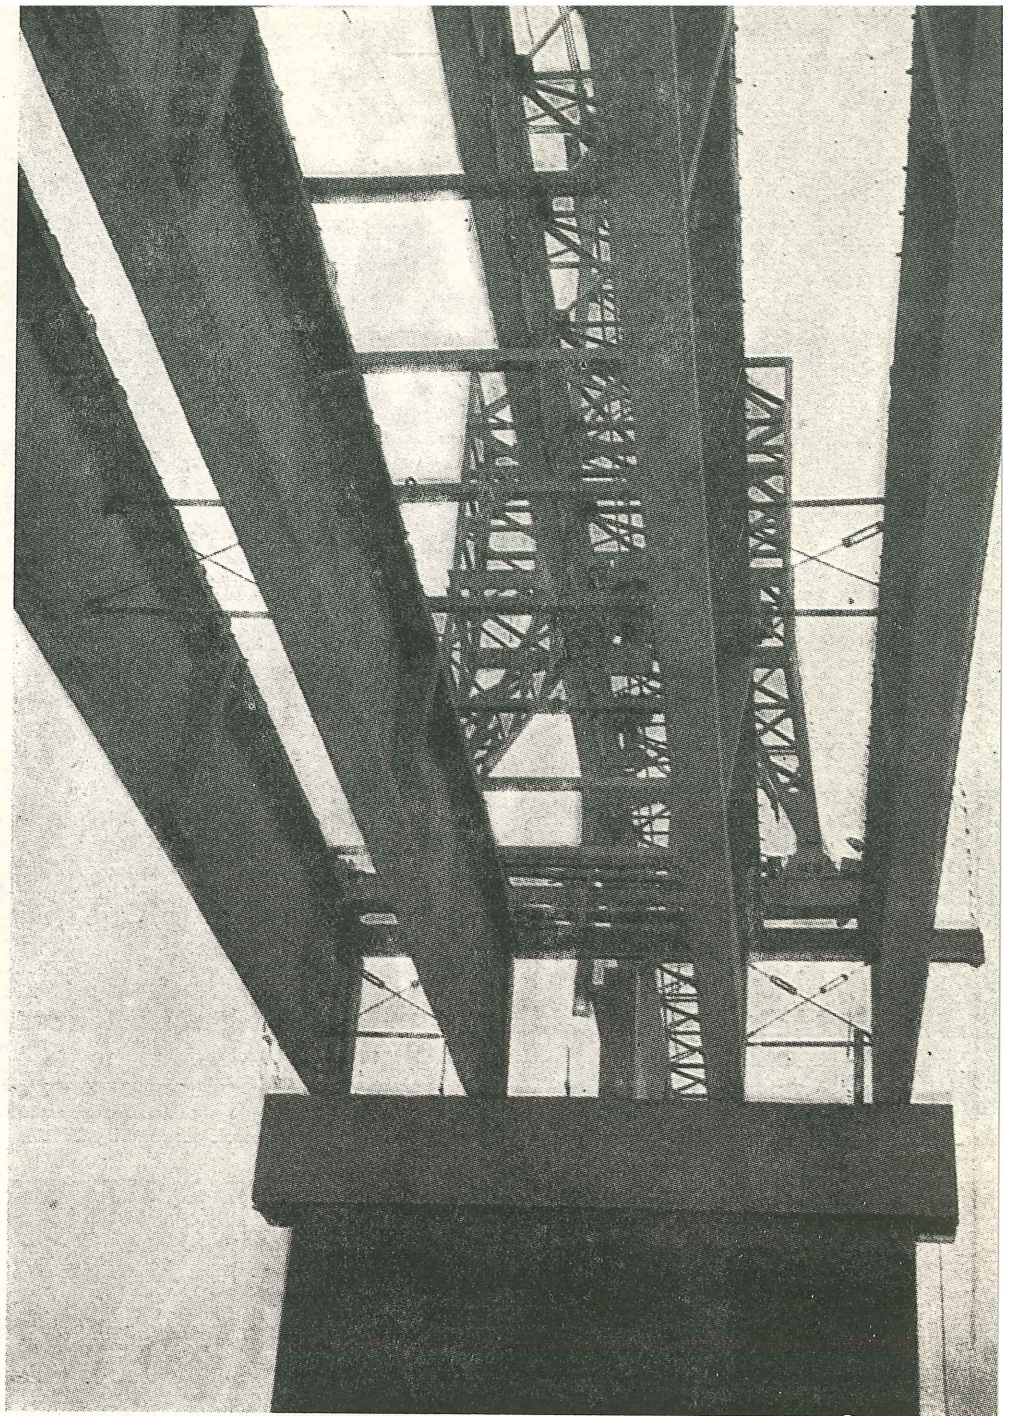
Vista inferior de uno de los tramos, durante la colocación de las riostras metálicas, entre vigas
